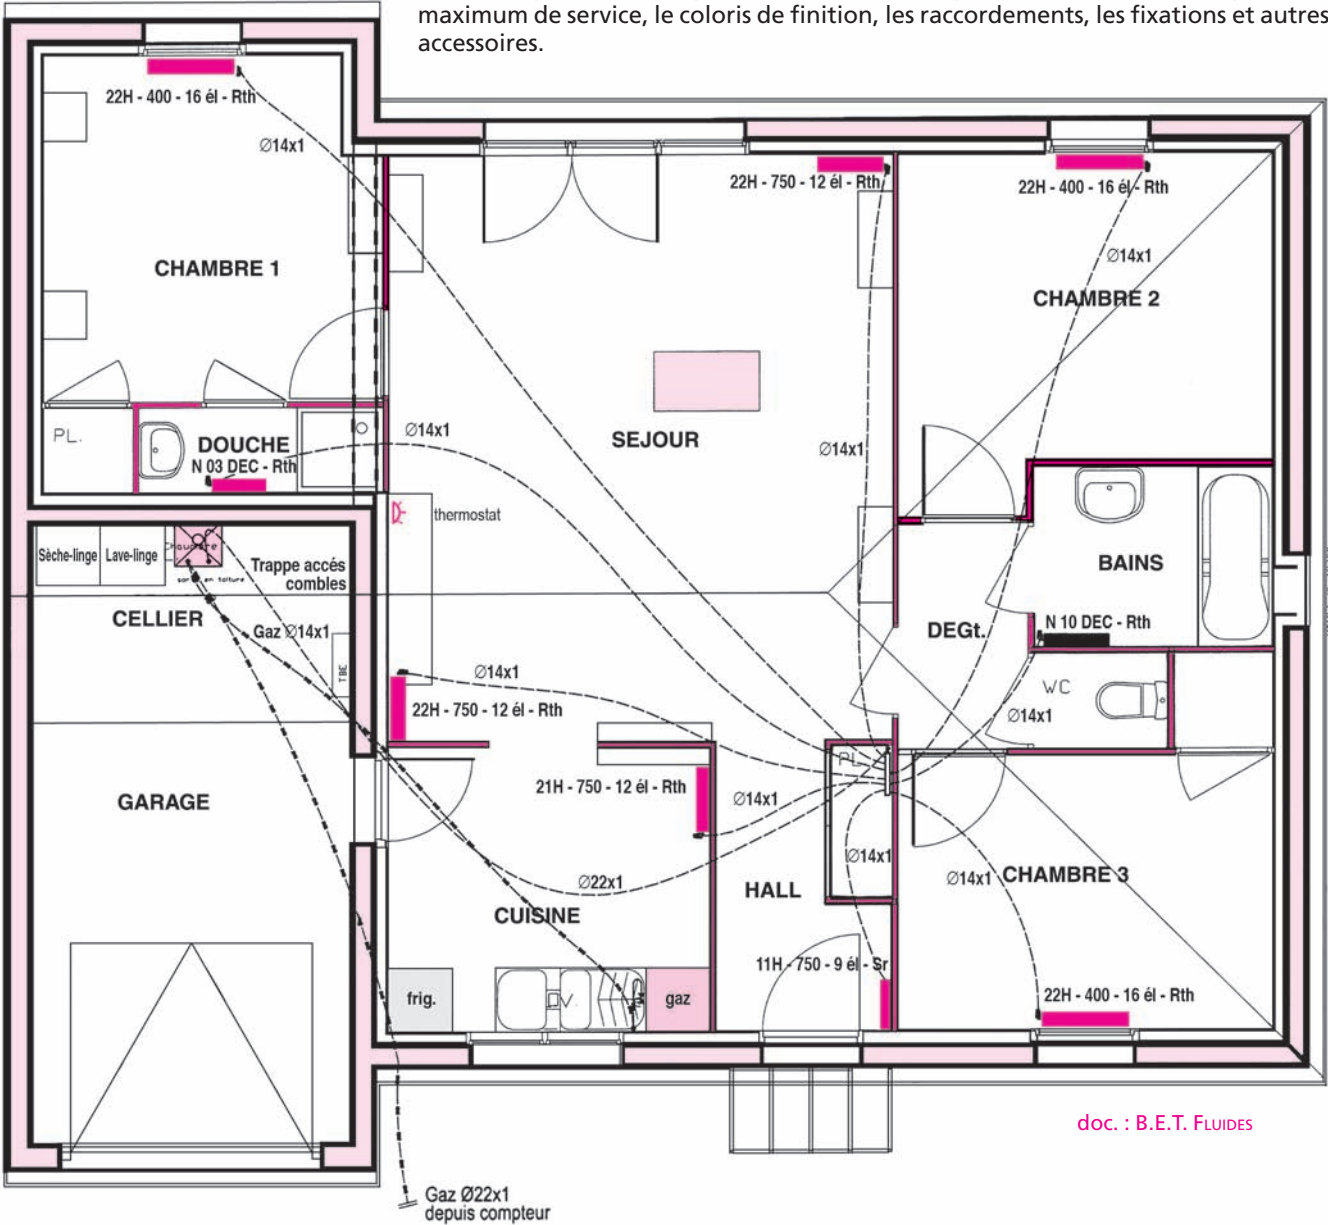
Plan d’installation du chauffage avec alimentation intérieure en gaz
